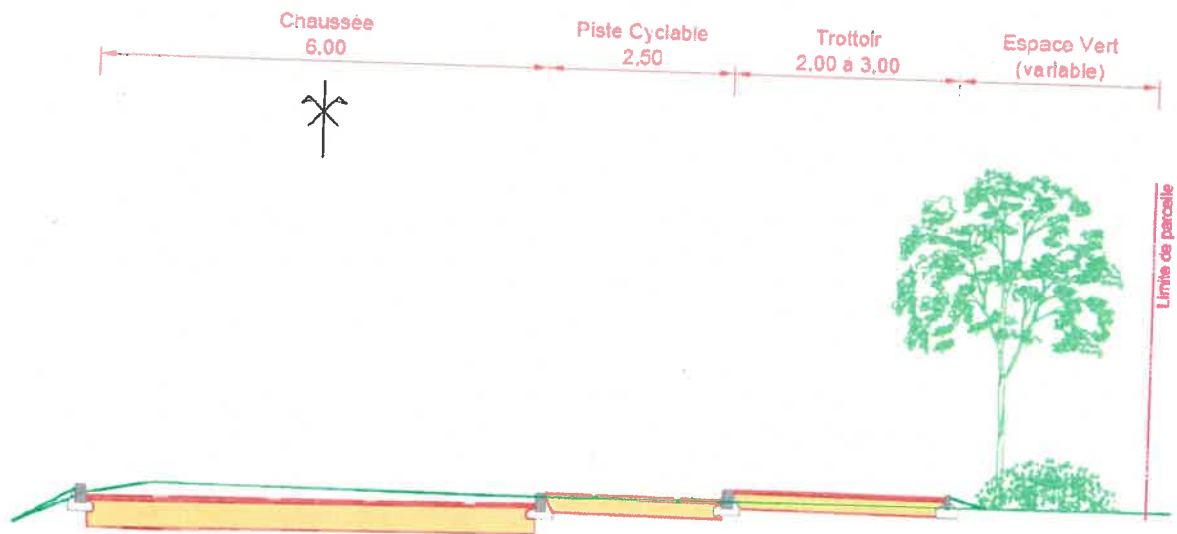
Coupe de principe sud-nord du barreau Marcellin Allo (stade études préliminaires)
